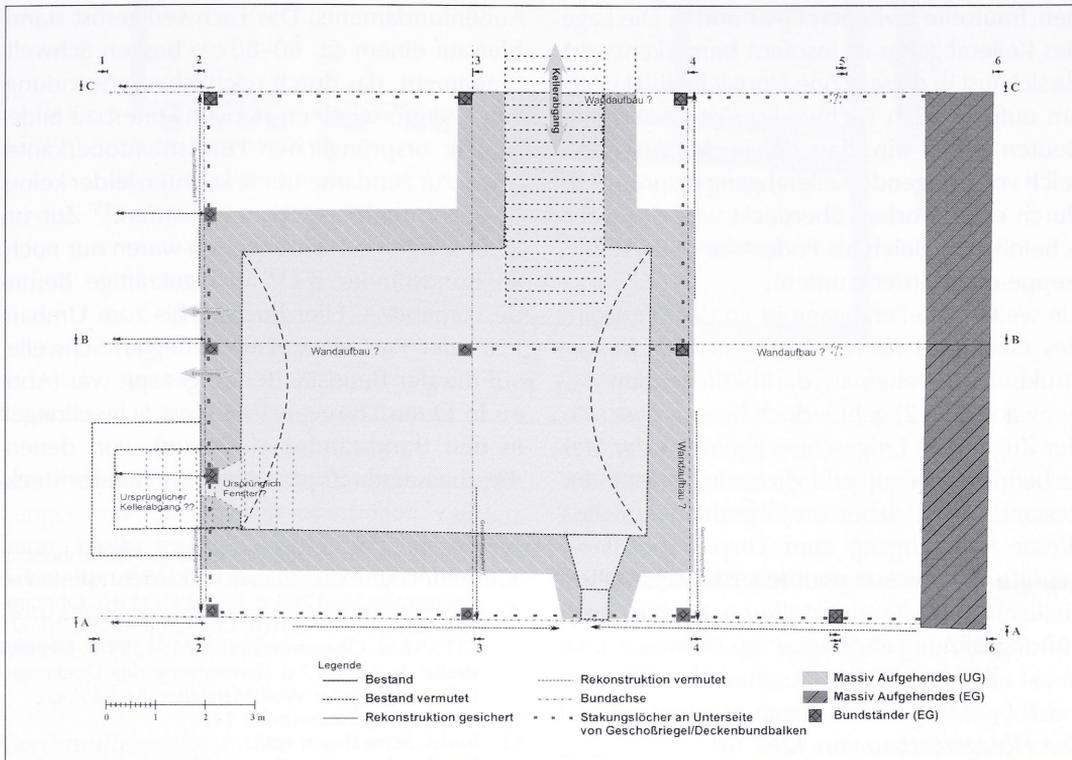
Reutlingen, Kanzleistraße 24. Grundriss Untergeschoss/Erdgeschoss, Rekonstruktion Zustand 1267.
